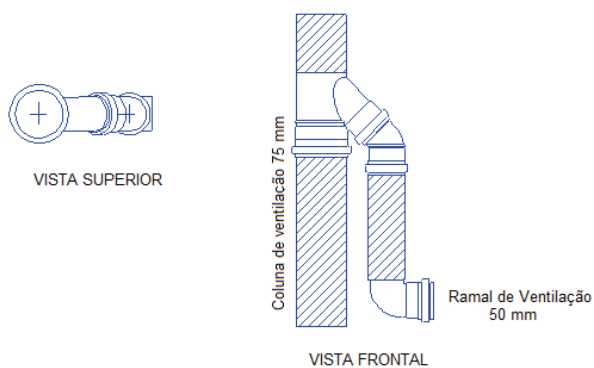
Detalhe da ligação do ramal de ventilação com a coluna de ventilação
